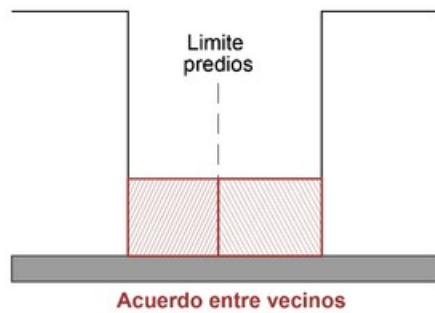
Posibilidad de utilizar el espacio de aislamiento lateral entre predios si hay acuerdo entre vecinos para construir la fachada activa.
